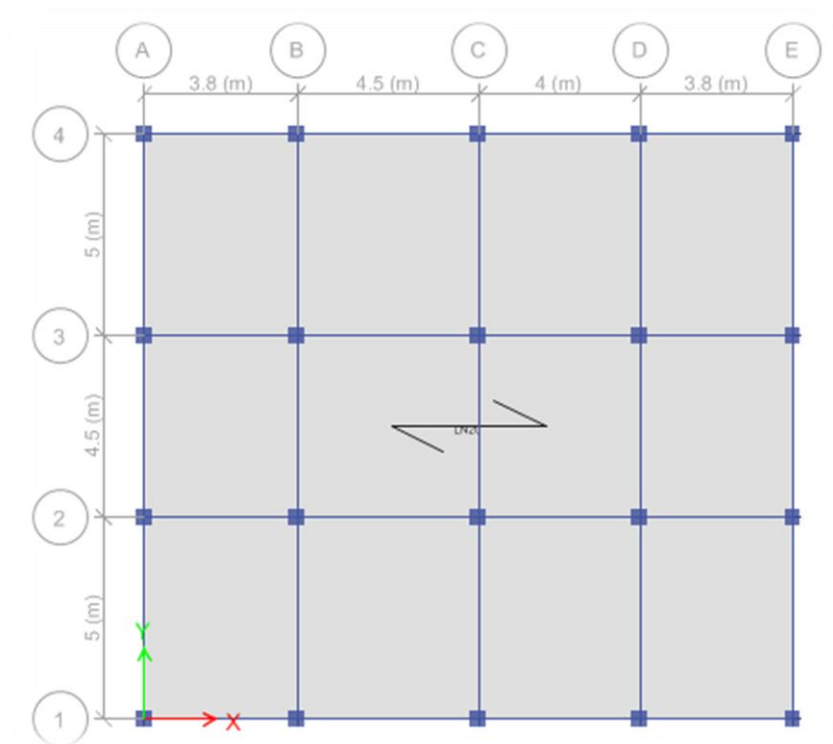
Vista de planta de edificación de 3 niveles con base empotrada. Fuente: elaboración propia.
